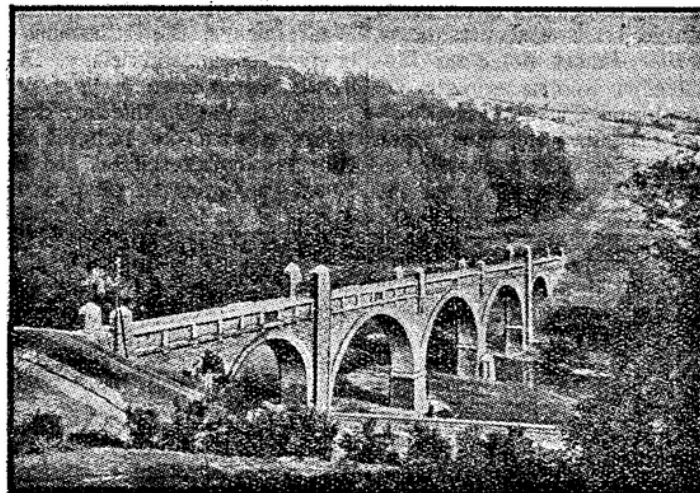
Wasserleitungsbrücke über das Zschopautal bei Waldkirchen
